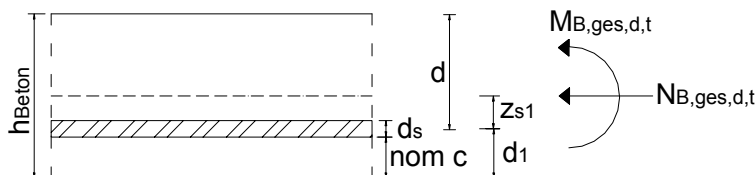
Längsschnitt durch die Betonplatte mit unterer Längsbewehrung (Fall 2)
